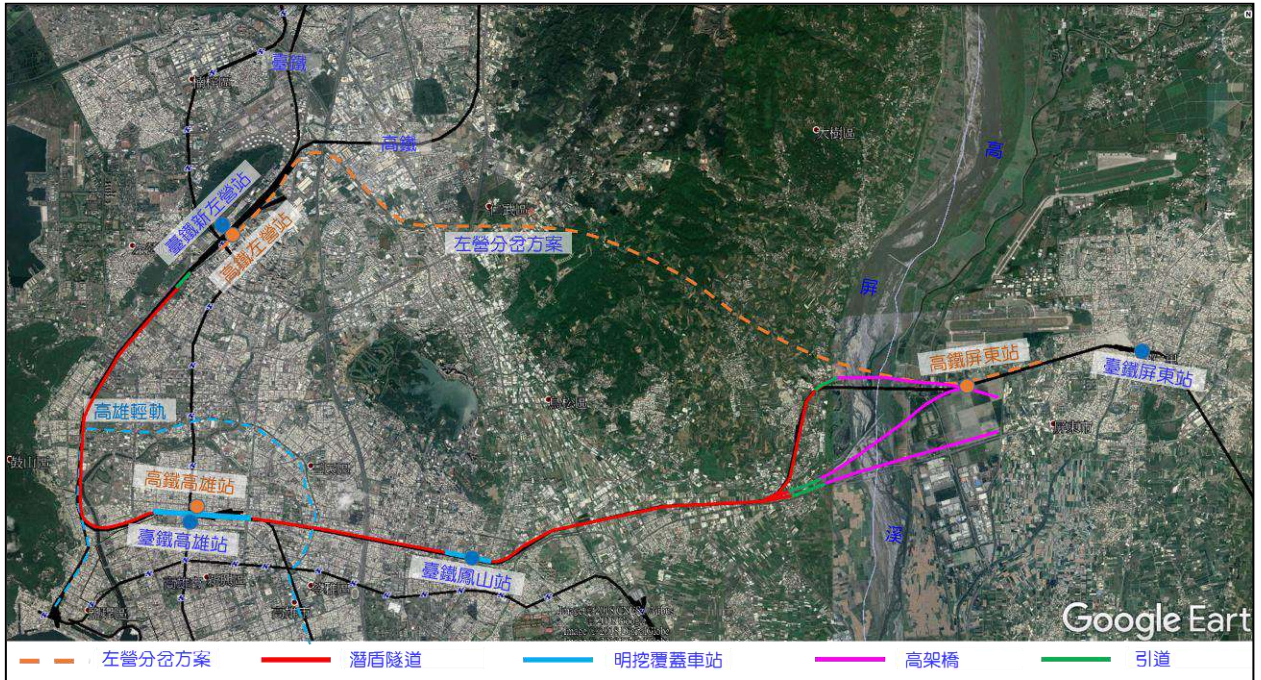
高鐵沿臺鐵延伸進入高雄及屏東路線方案平面圖
